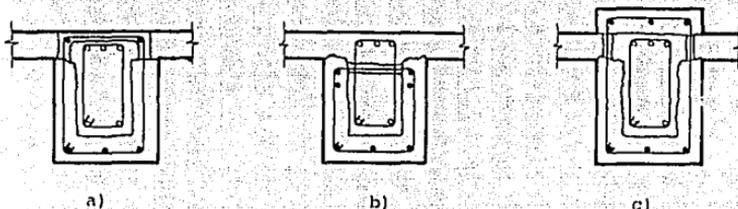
Encamisado por flexión y cortante de vigas con concreto reforzado.
